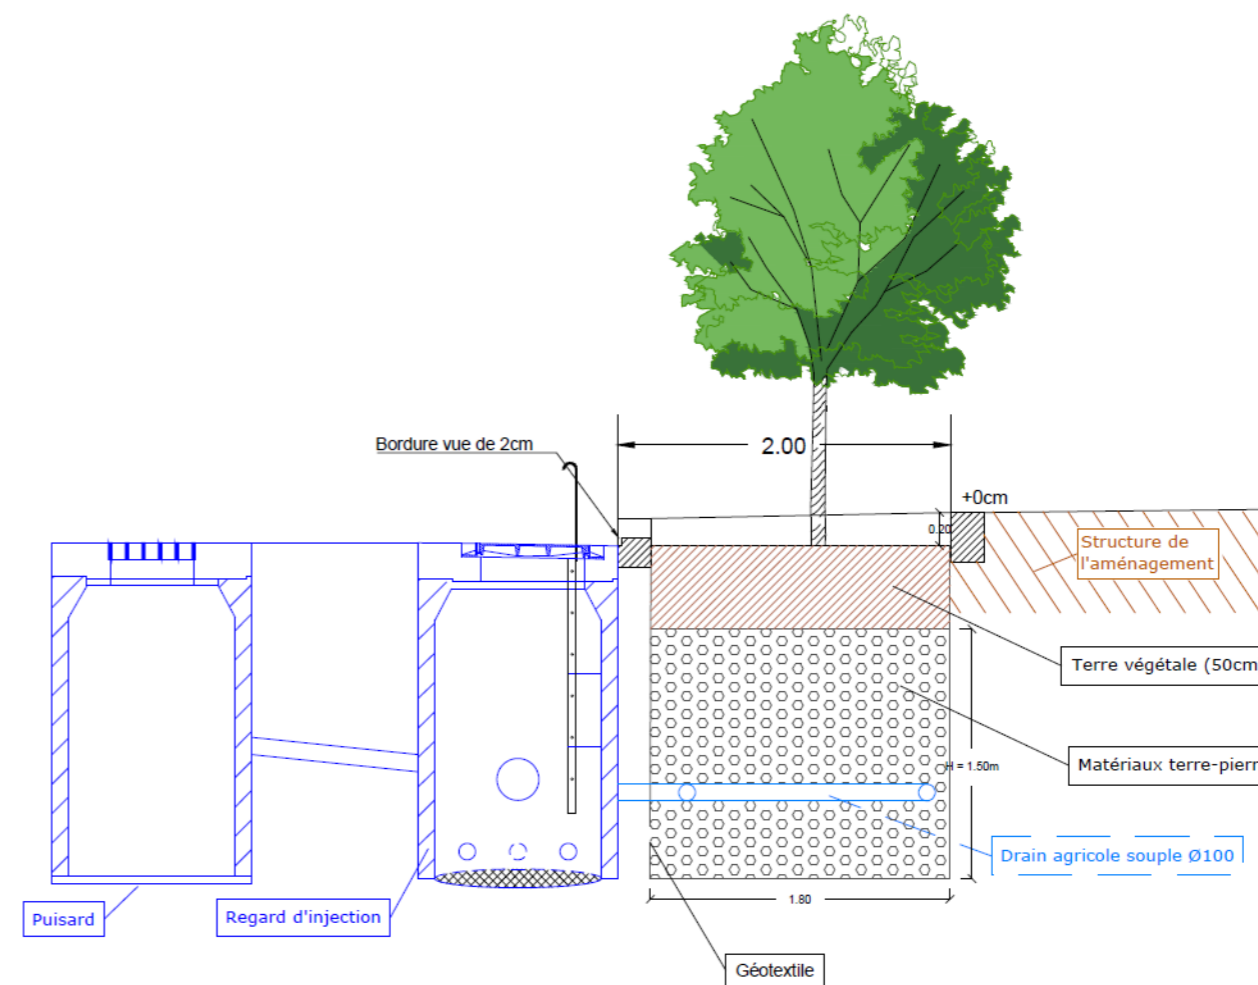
COUPE-TYPE D'UN OUVRAGE DE TYPE TRANCHEE DE STOCKHOLM
